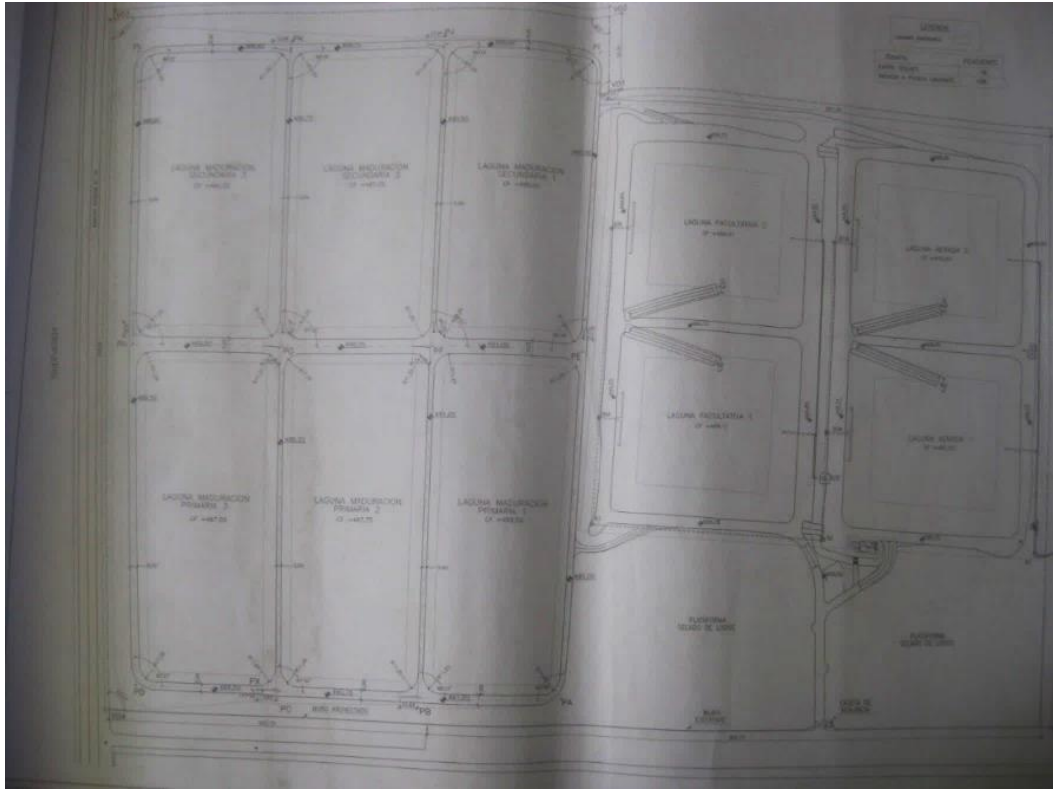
Propuesta de Lagunas de Maduración para la planta de tratamiento COPARE
